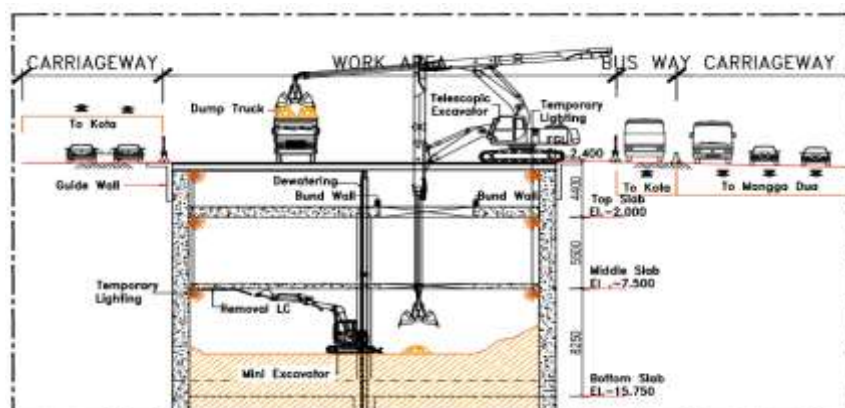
Menurunkan Mini Excavator ke Bottom Slab
